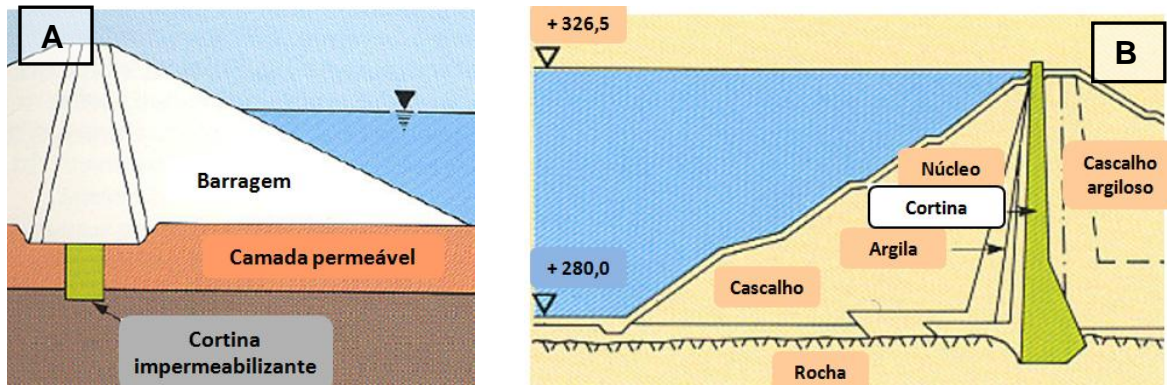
Cortinas impermeabilizantes com elementos de *jet grouting* no solo de fundação de barragens de aterro (A) e no núcleo de barragens de aterro (B) (adaptado de Pinto (2012b))
